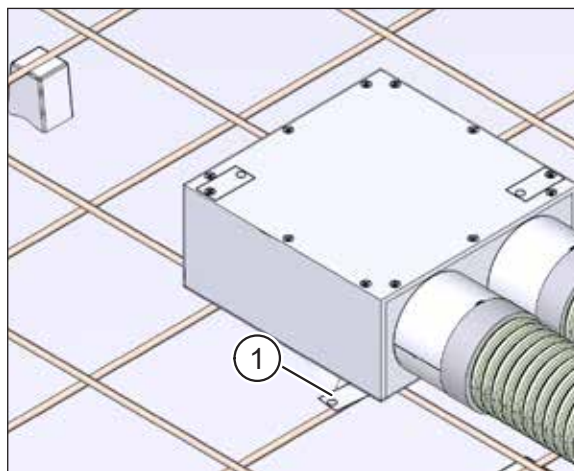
Fixer le caisson de plafond en tôle d'acier sur le béton coulé sur place
